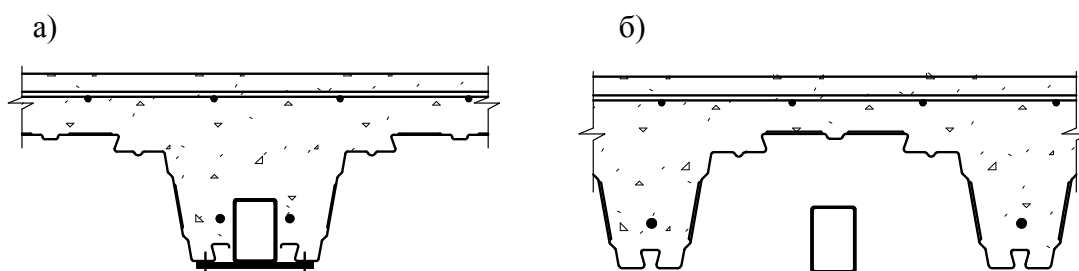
Повышение огнестойкости плиты перекрытия с профилированным настилом путем усиления растянутой зоны жесткой арматурой (а) и гибкими стержнями (б) [13]
